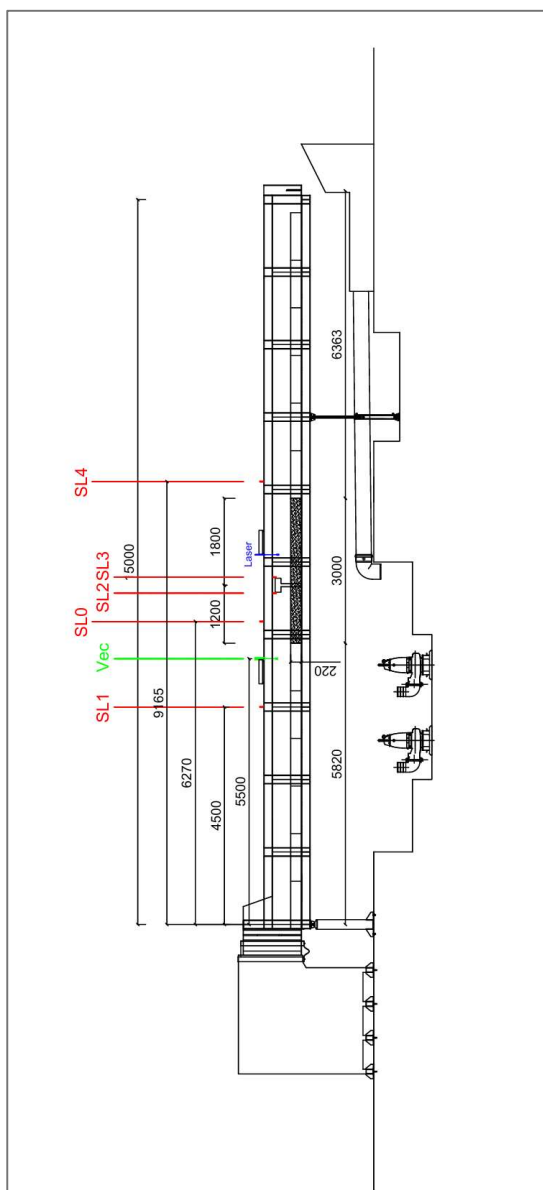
Vista laterale del canale con posizione dei vari strumenti.
